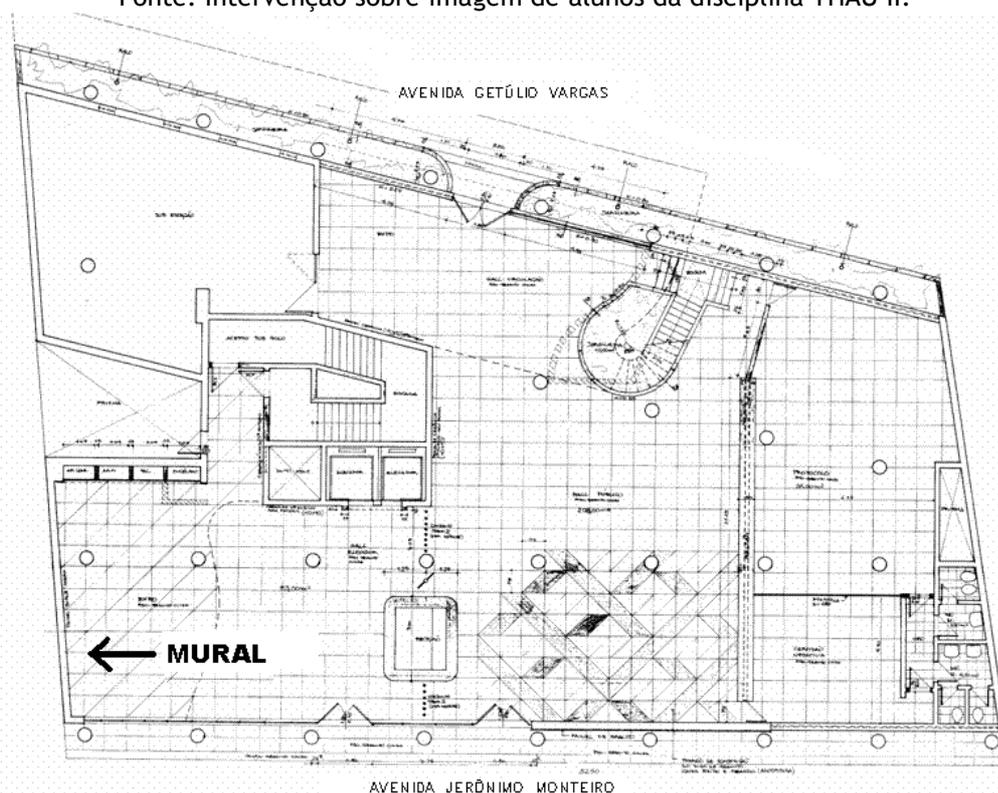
Planta baixa do pavimento térreo. Localização do mural no hall do edifício<sup>174</sup>.
